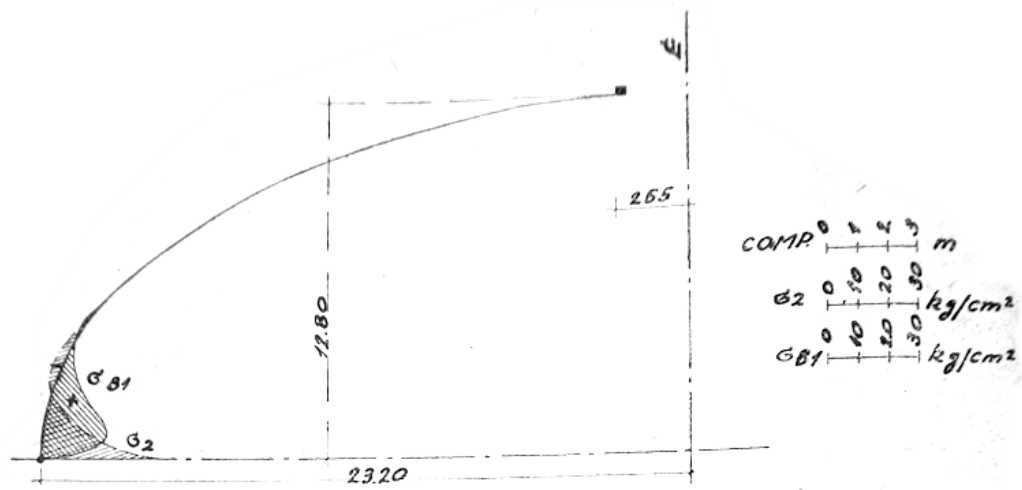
Tensões provocadas na casca pelo hiperestático. FONTE: CONCRETO, 1943.
